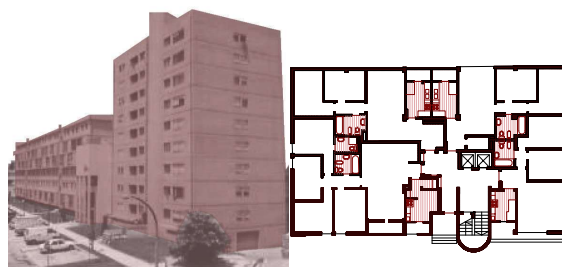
Prémio INH 1995 - fotografia e planta habitação tipo
